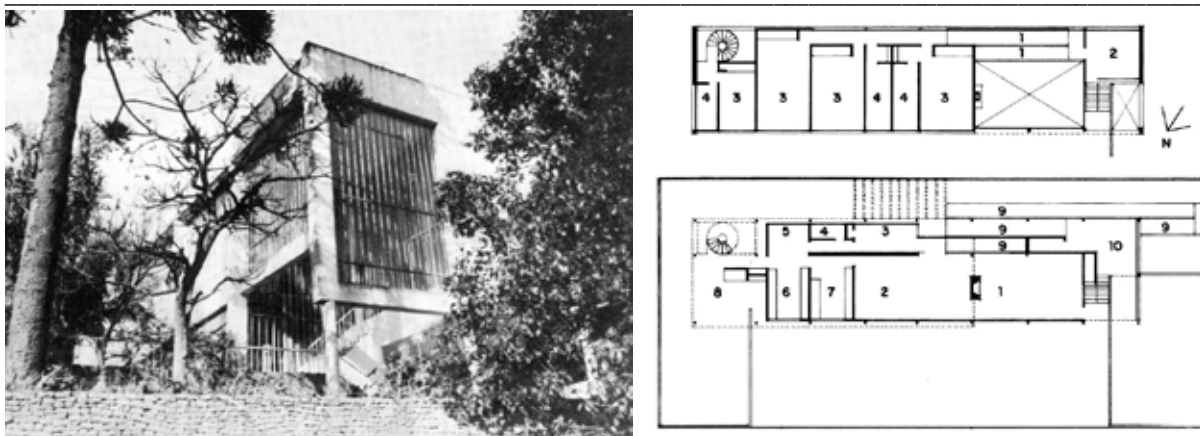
Casa João Luiz Bettega (1952), projetada por João Batista Vilanova Artigas e construída em Curitiba.
